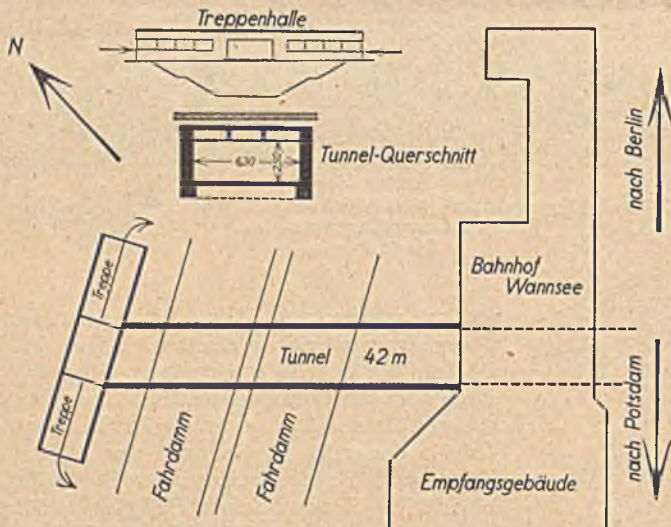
Fußgängertunnel unter der Bahnhofstraße in Berlin-Wannsee. — Lageplan und Schnitte.
